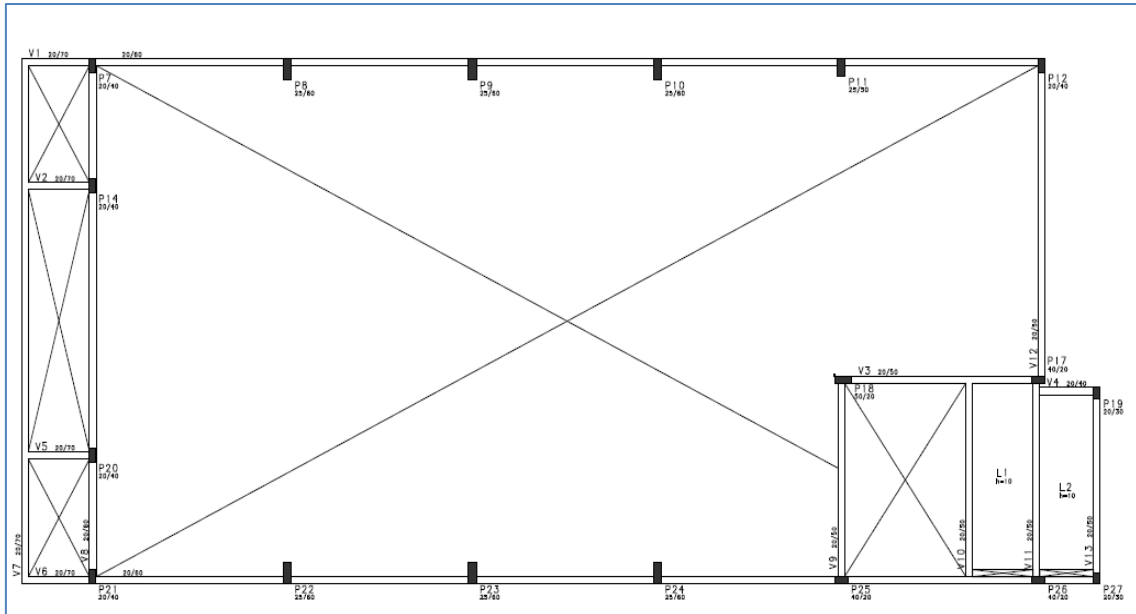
Planta de fôrma: cobertura, concreto protendido (CAD/TQS)
